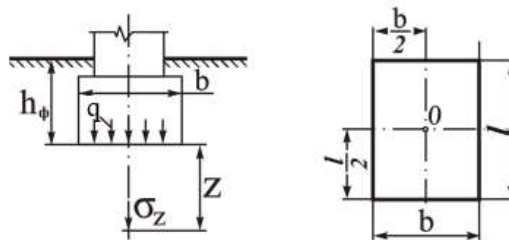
Схема до розрахунку напружень в ґрунті під центром фундаменту: а – перетин; б – план фундаменту
